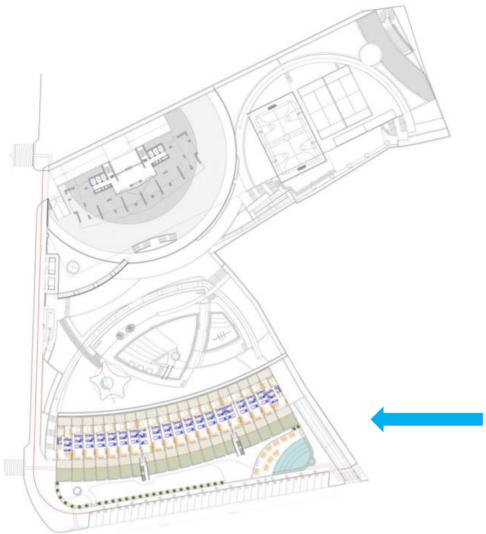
Plano emplazamiento de los alojamientos turísticos.
